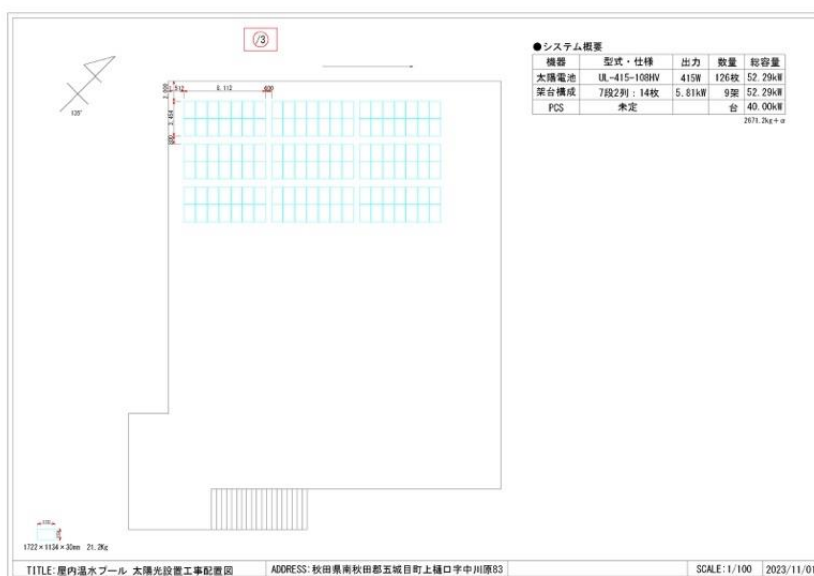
屋内温水プール 太陽光設置工事配置図
